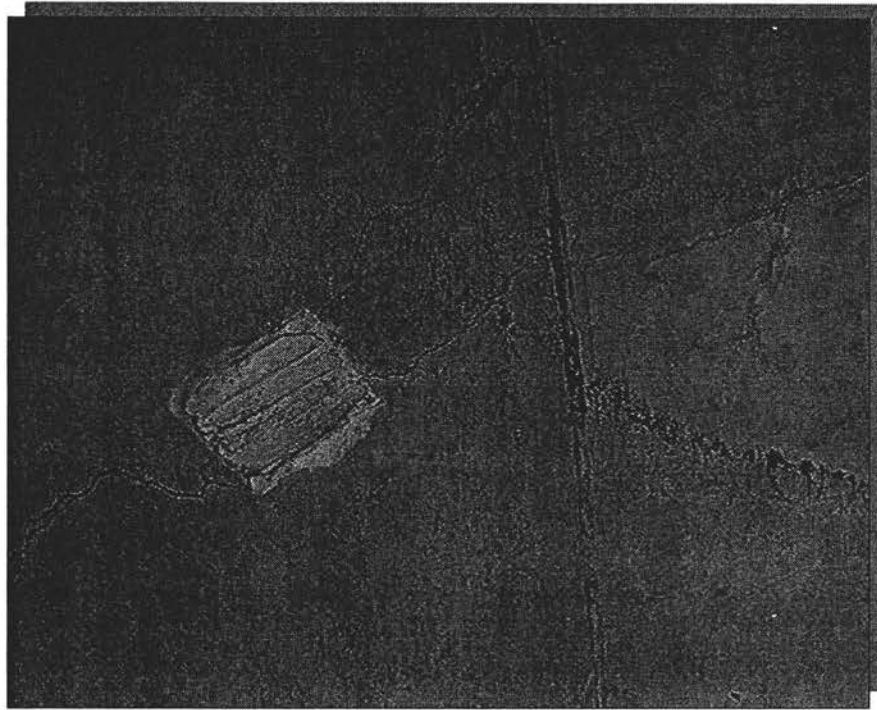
Grietas (acercamiento) en columnas dañadas
